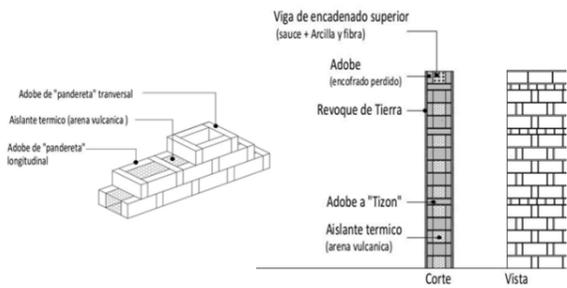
(izq.). Detalle constructivo de la pared de adobe "enuacalado" | Imagen de "Debarro Arquitectura"
